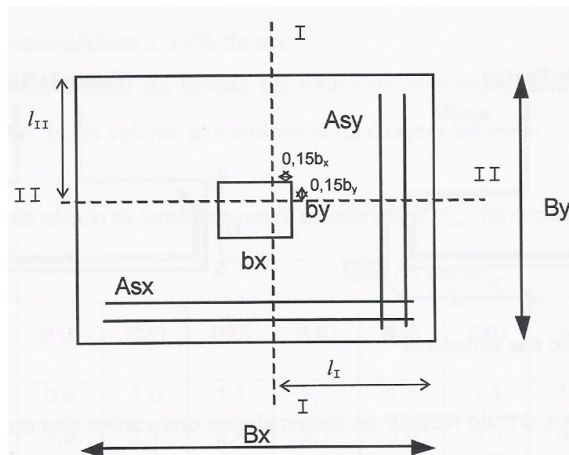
Modelo de flexão para o cálculo das armaduras de uma sapata
